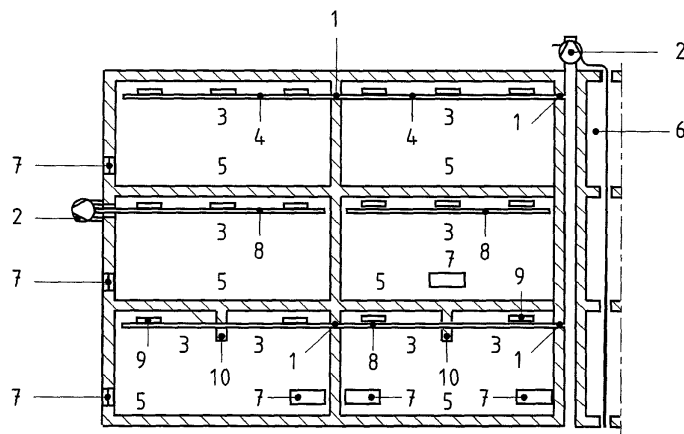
А. Механическая вентиляция тепло- и дымоудаления в одном помещении с наружным вентилятором
